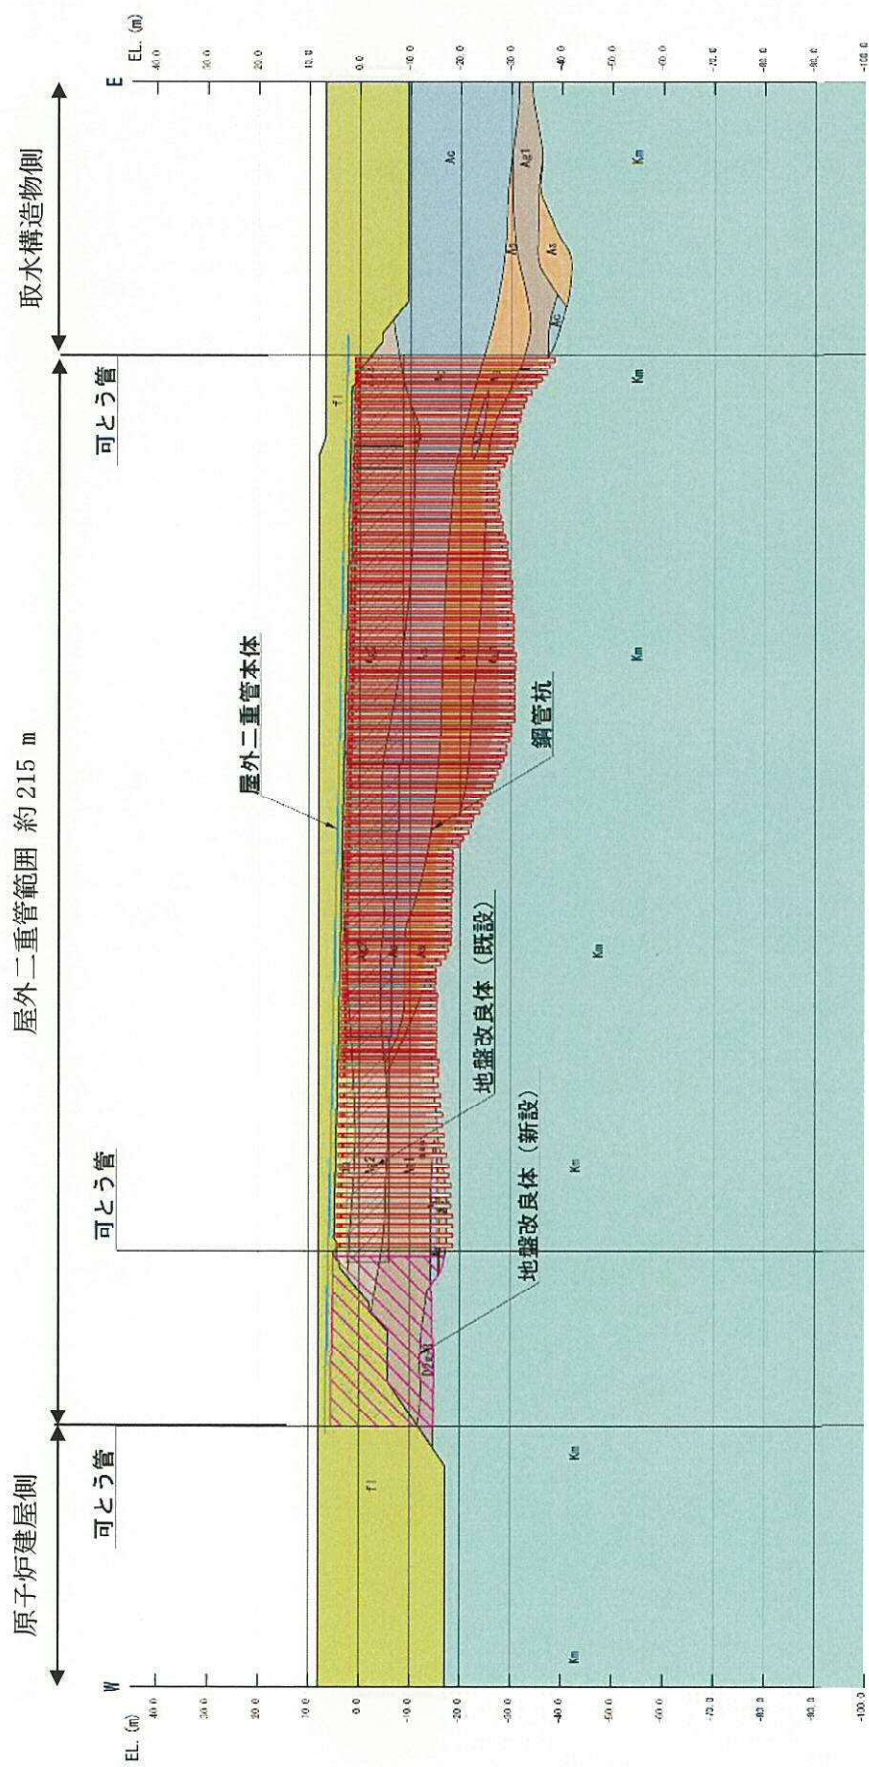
(1) 屋外二重管の縦断面図 (A-A断面)
